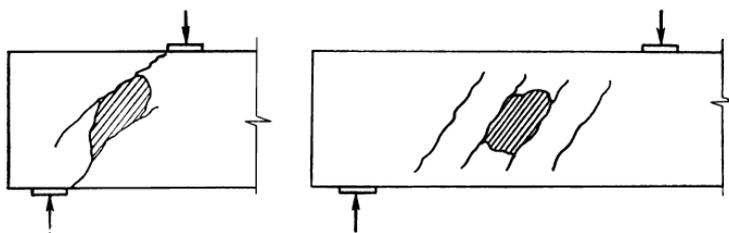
Разрушение по сжатой полосе между наклонными трещинами [1]
